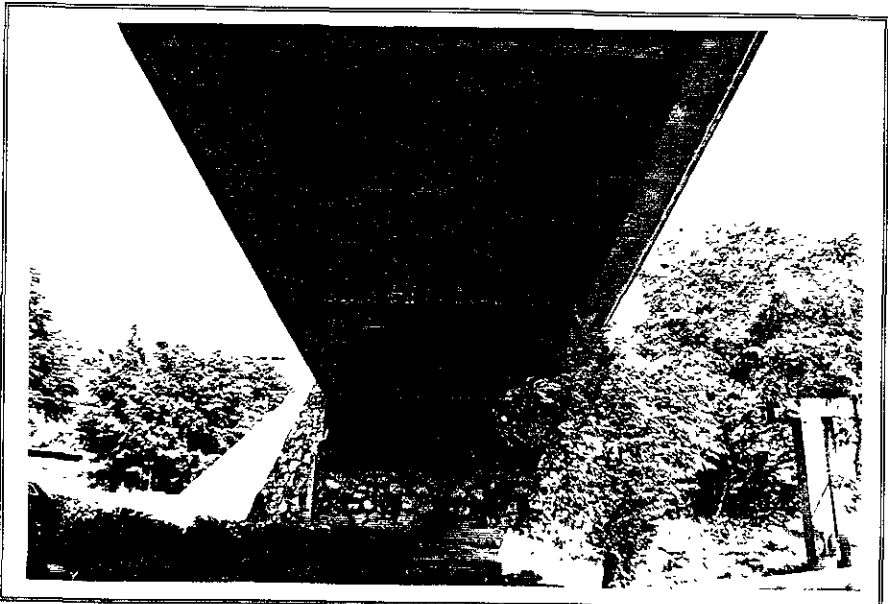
Vista del caballete No. 1 y superestructura del lado derecho
